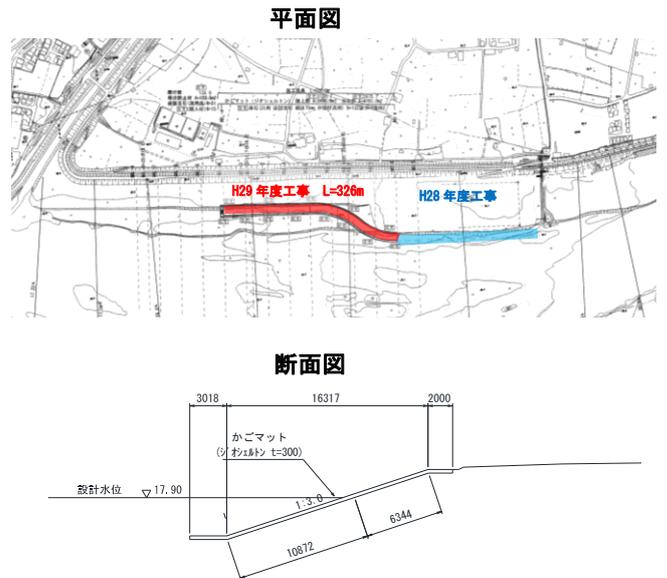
岩出狭窄部低水護岸工事 平面図 断面図
